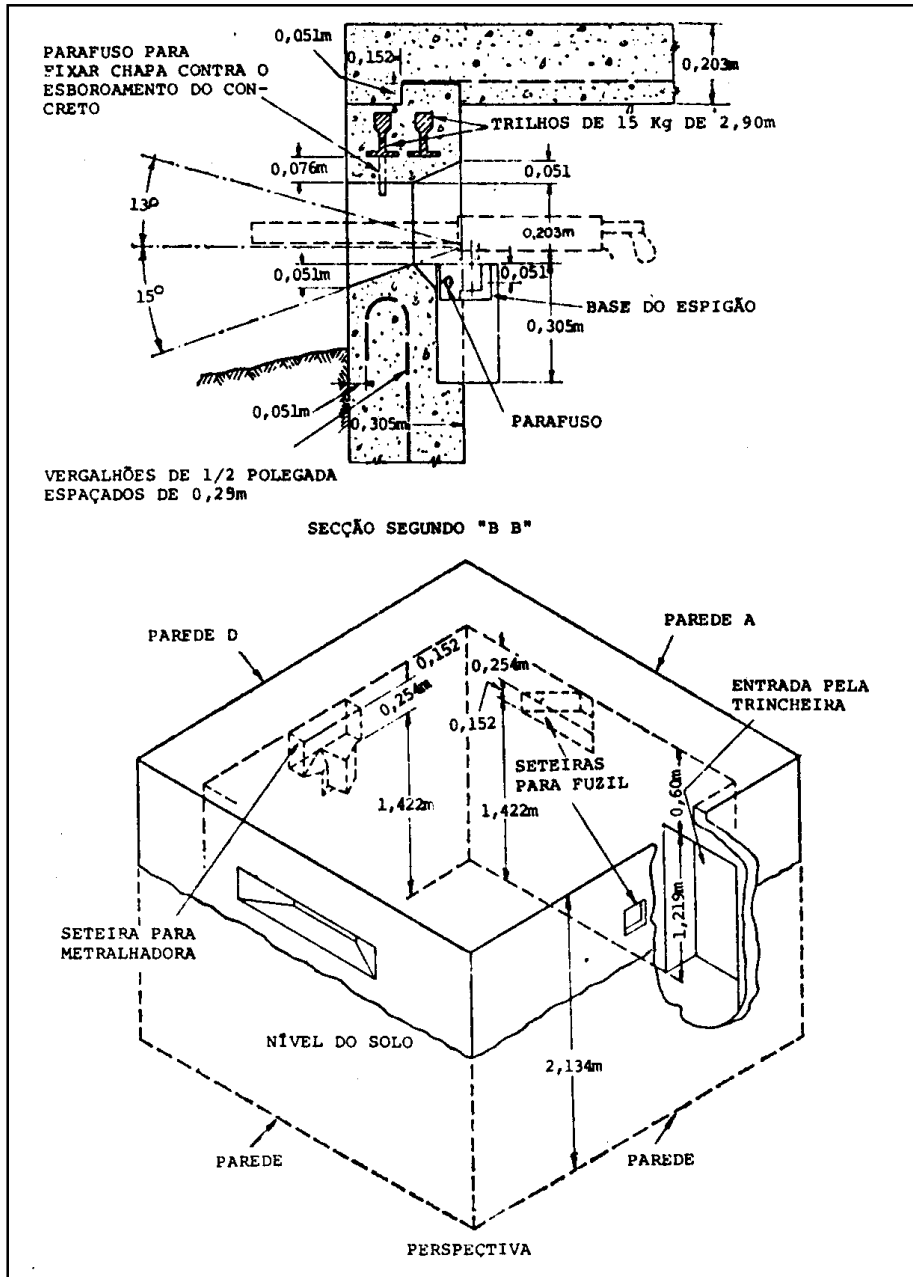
Planta de casamata quadrada, de concreto armado, para metralhadora
